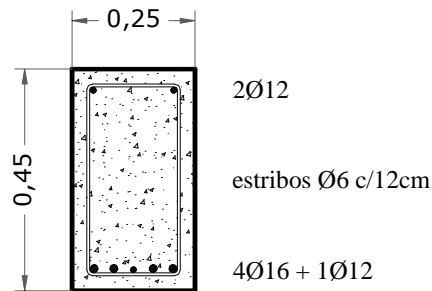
Dimensiones de Viga de Fundación de Muros Portantes.
